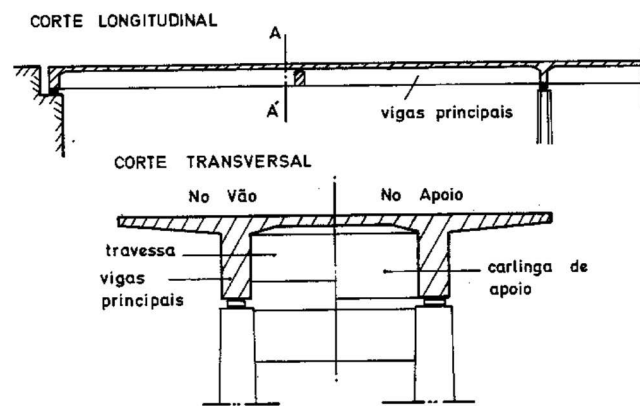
Ponte em laje vigada de betão armado (Reis, 1999).
